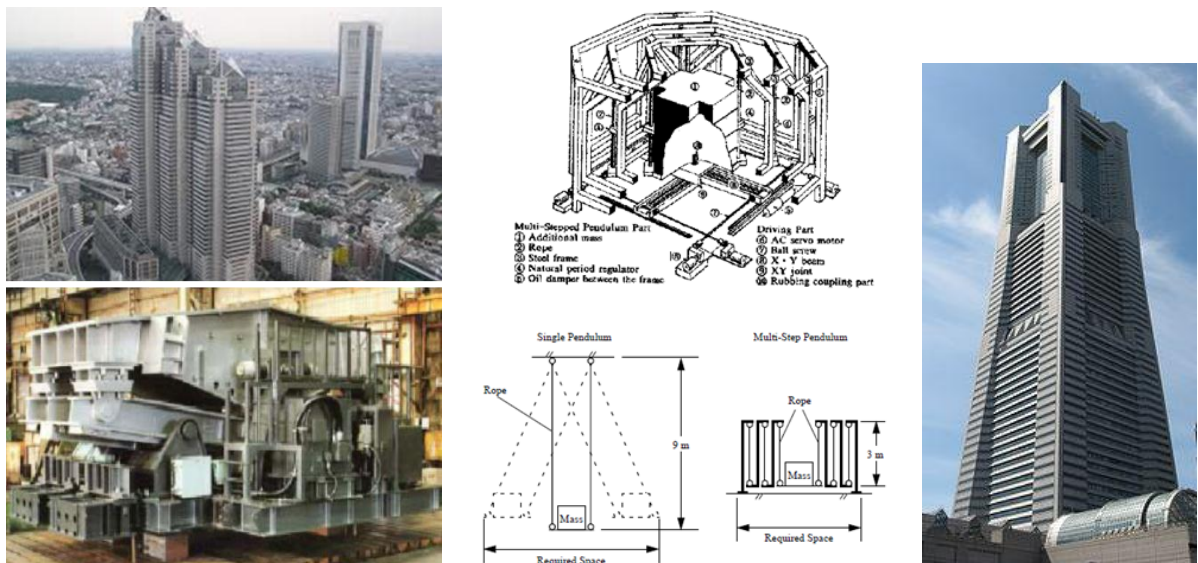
Dispositivos de control híbrido, edificio Shinjuku Park Tower y Yokohama Landmark (Japón) (Spencer y Nagarajaiah 2003)
